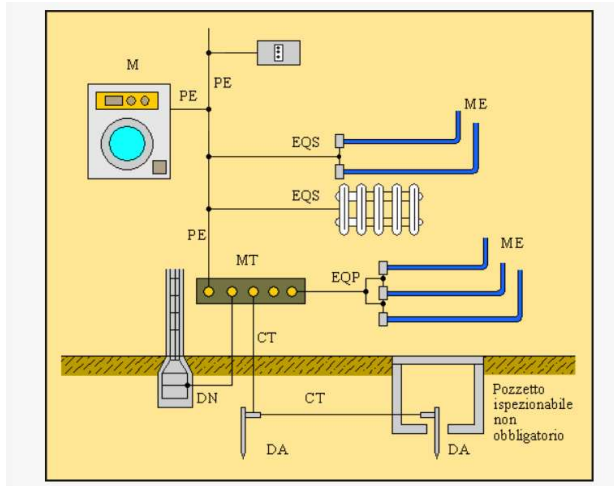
Schema elementi fondamentali impianto di terra (Fonte elektro.it)
